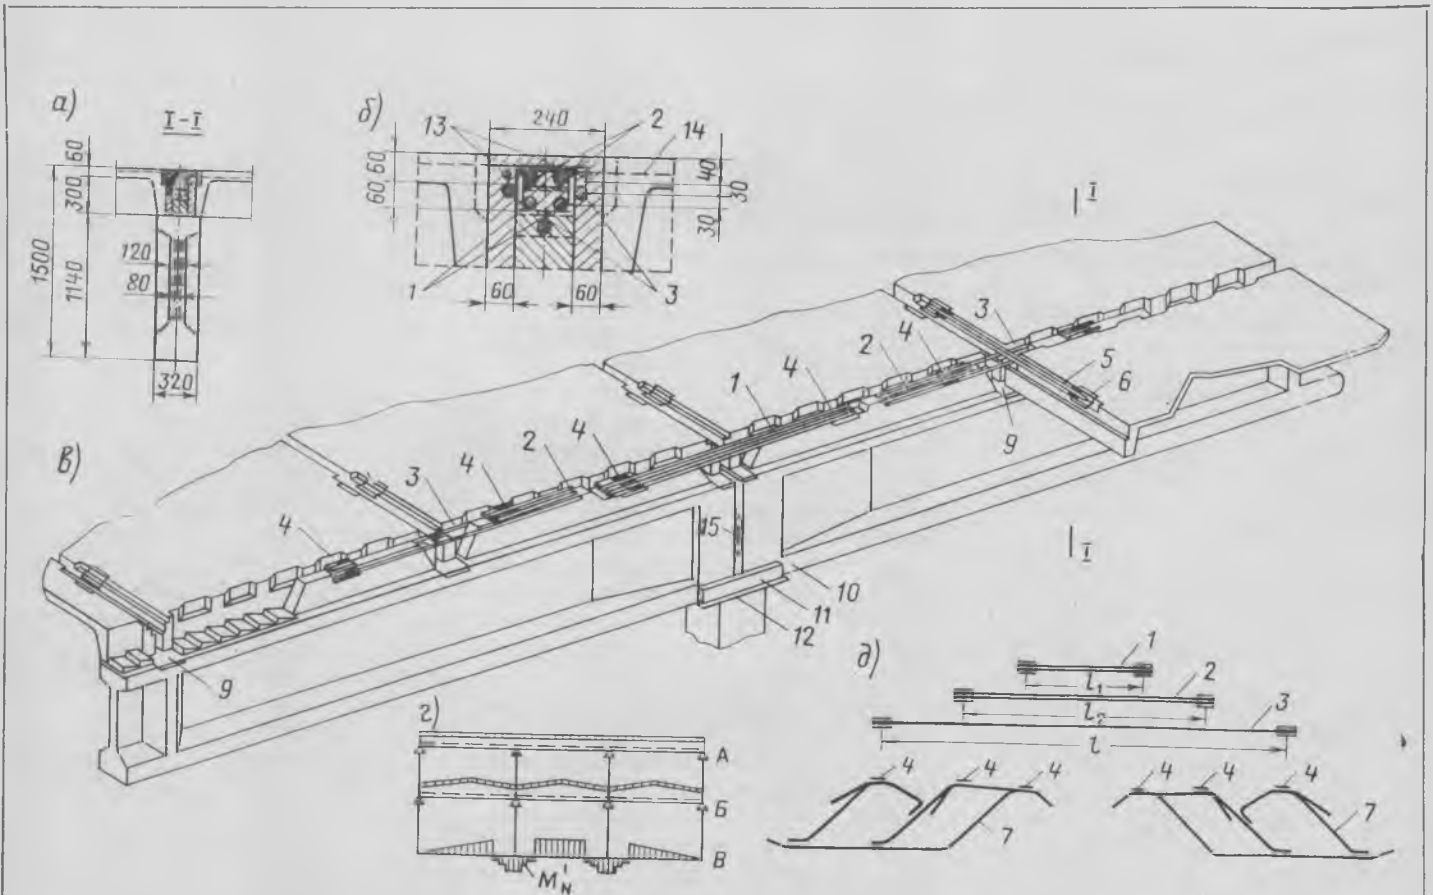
Стык с предварительно напряженной арматурой сборно-монолитных неразрезных конструкций покрытий
